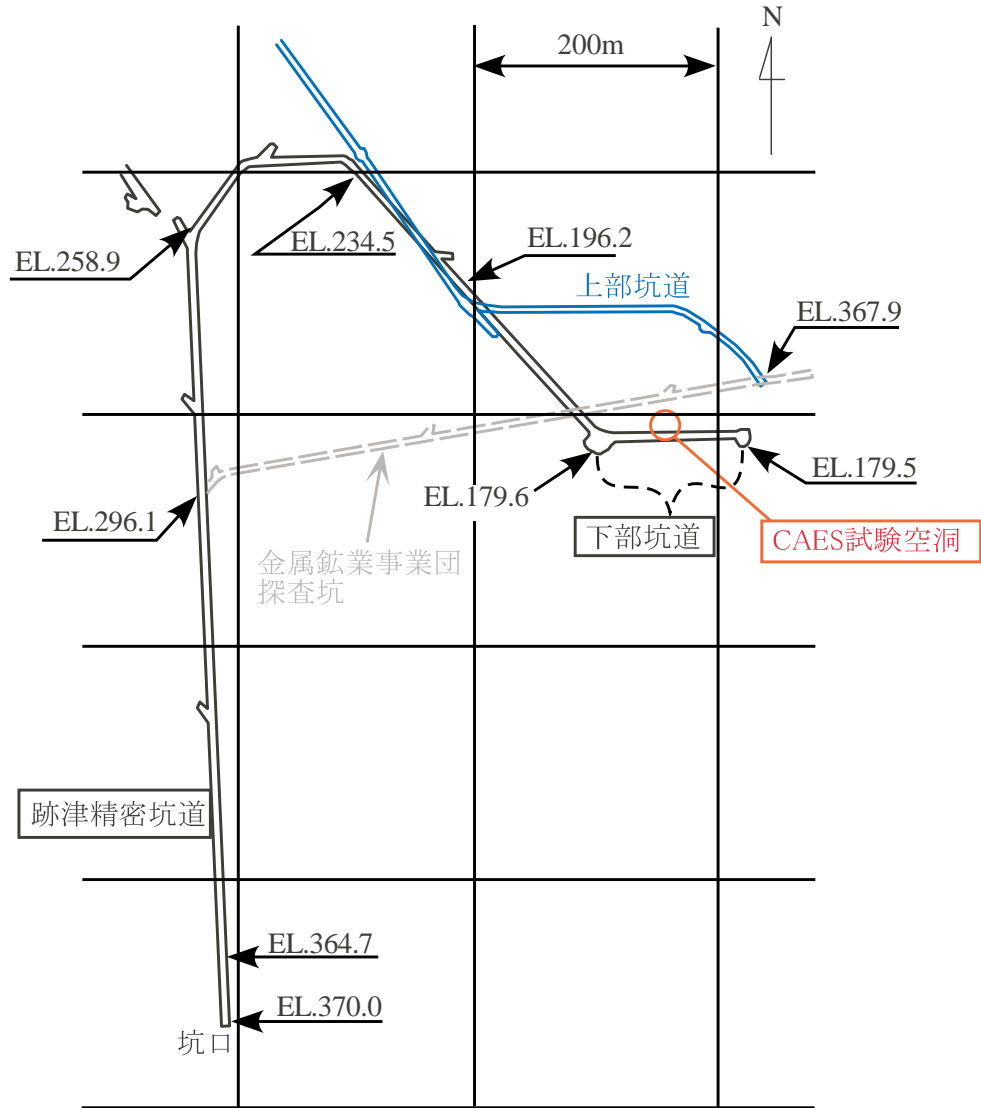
周辺坑道配置平面図 (中川ほか, 2003)
